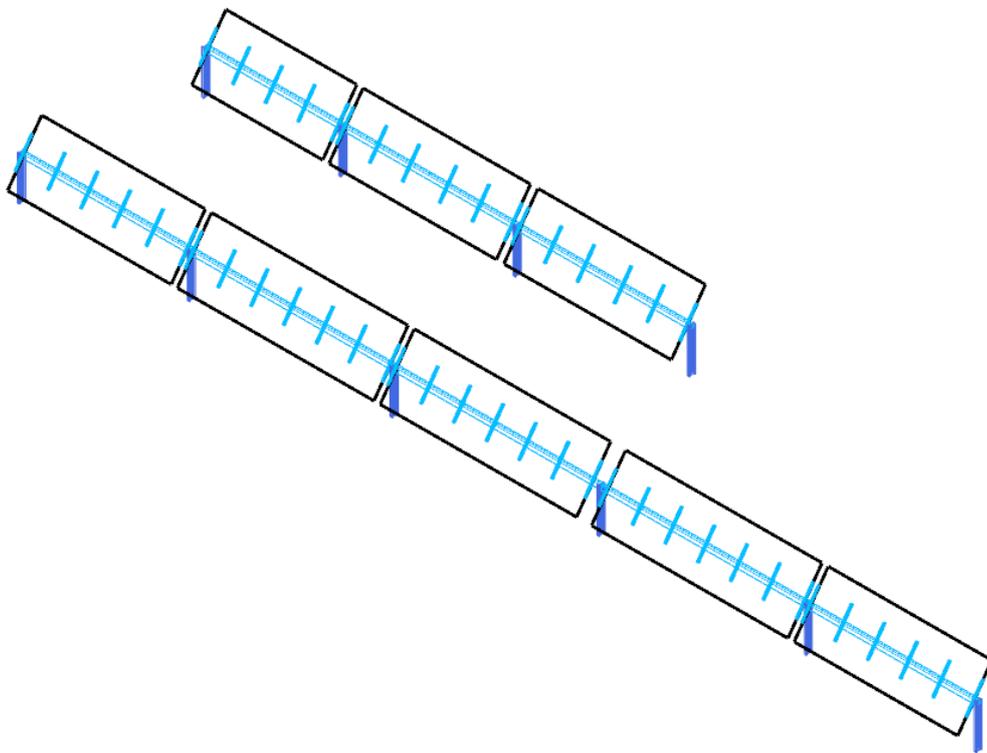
Vista assonometrica modello strutturale con posizione della “vela” inclinata di 55°
